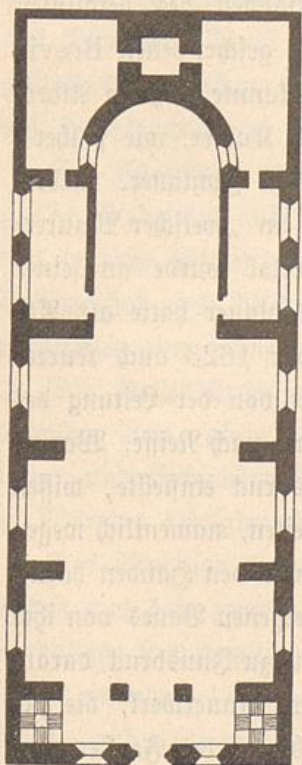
Innsbruck. Kollegienkirche von 1619. Grundriß. (Nach Originalgrundriß.)
